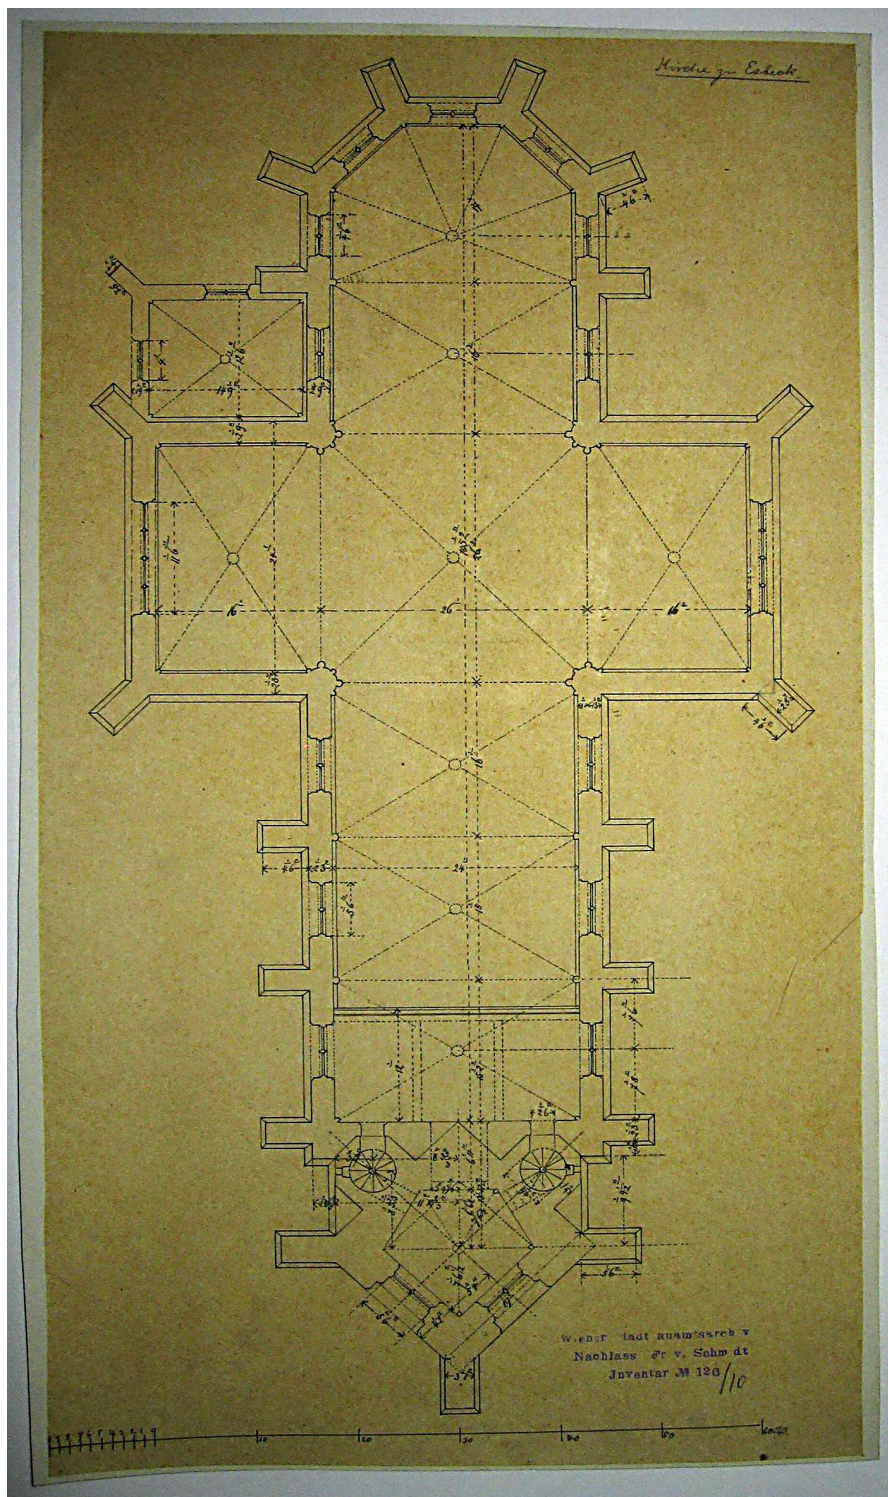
WM, Inv.-Nr. 157.126/10 erster Entwurf, Grundriss
